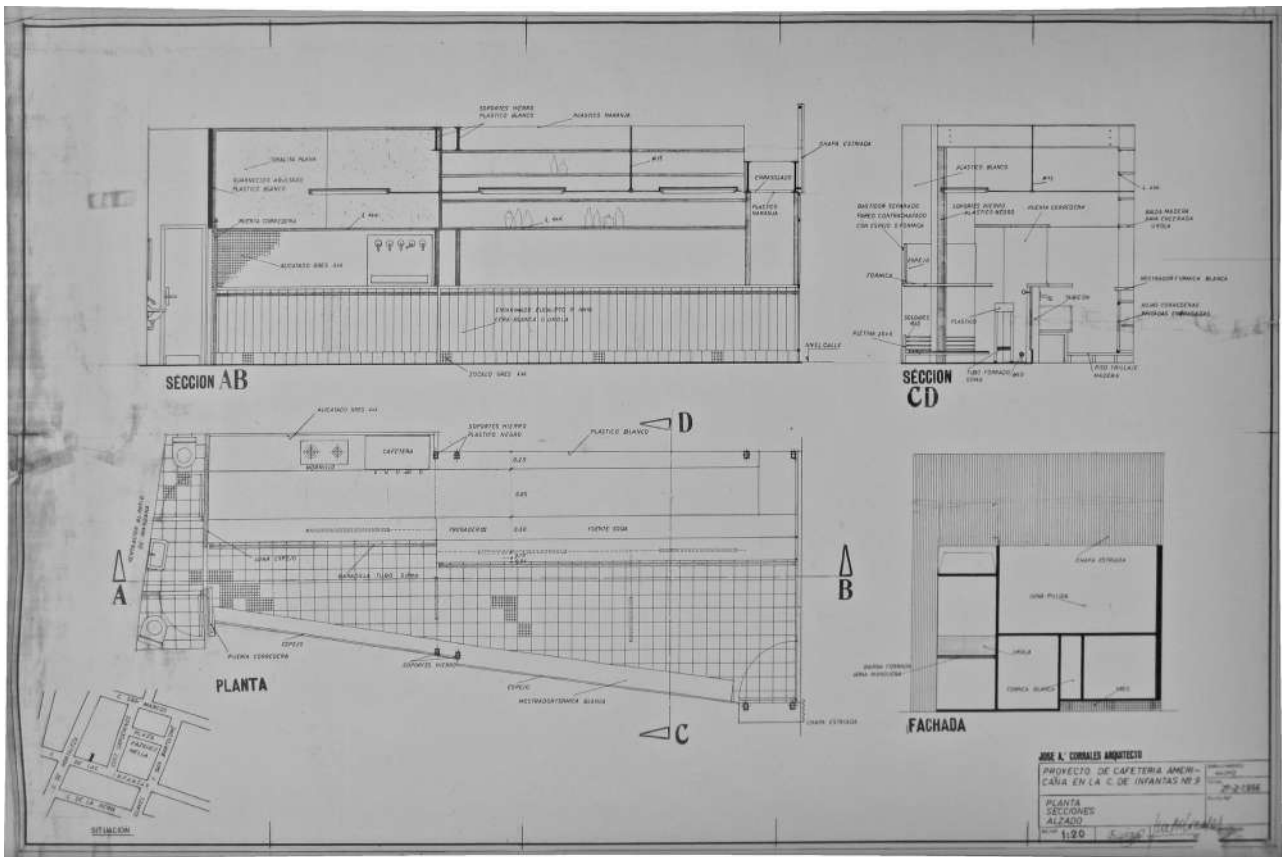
J.A. Corrales. Cafetería americana. Plano de proyecto. Plantas, secciones y alzado. Madrid. 1956. Archivo Corrales
